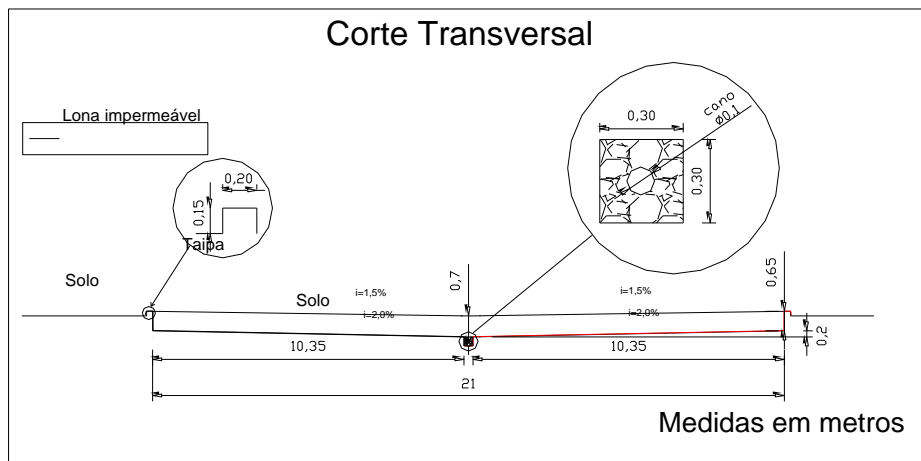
Corte transversal na parcela, detalhando o sistema de drenagem.
